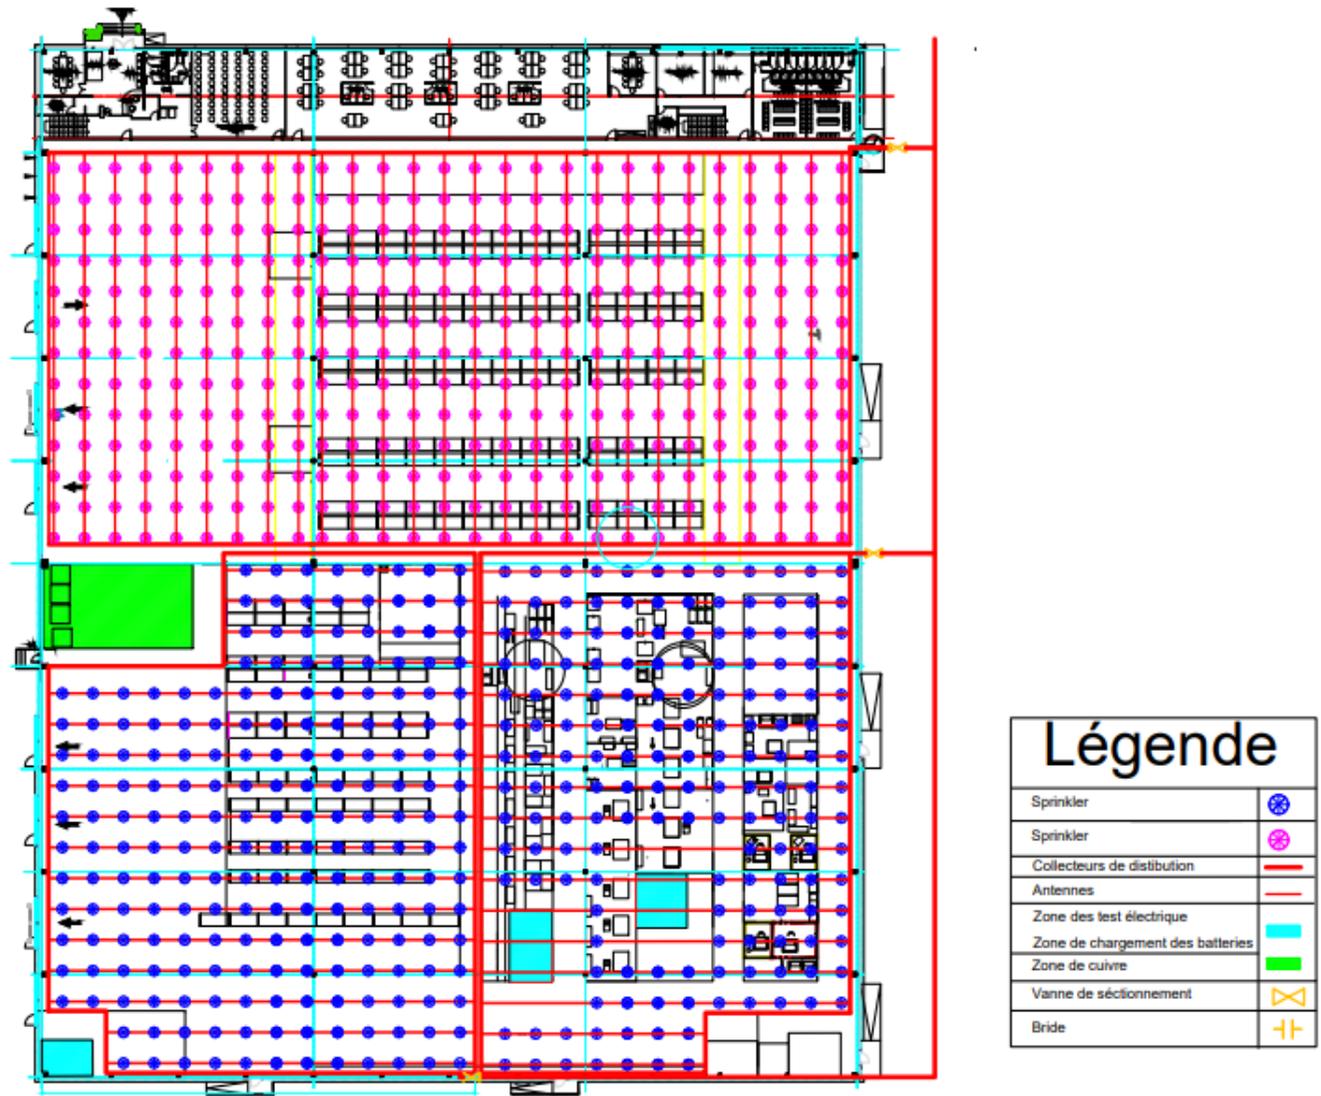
Plan de la conception des trois (3) systèmes de Sprinklers.
